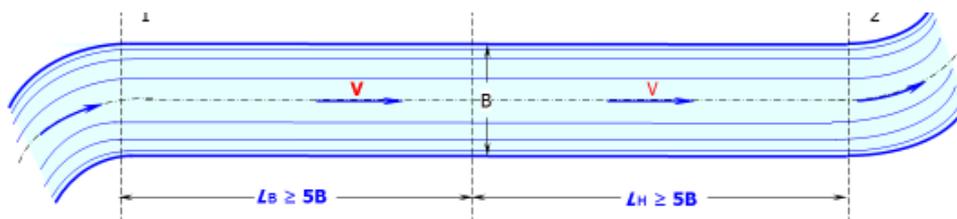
Продольный план выбранного участка канала для оборудования гидропоста
